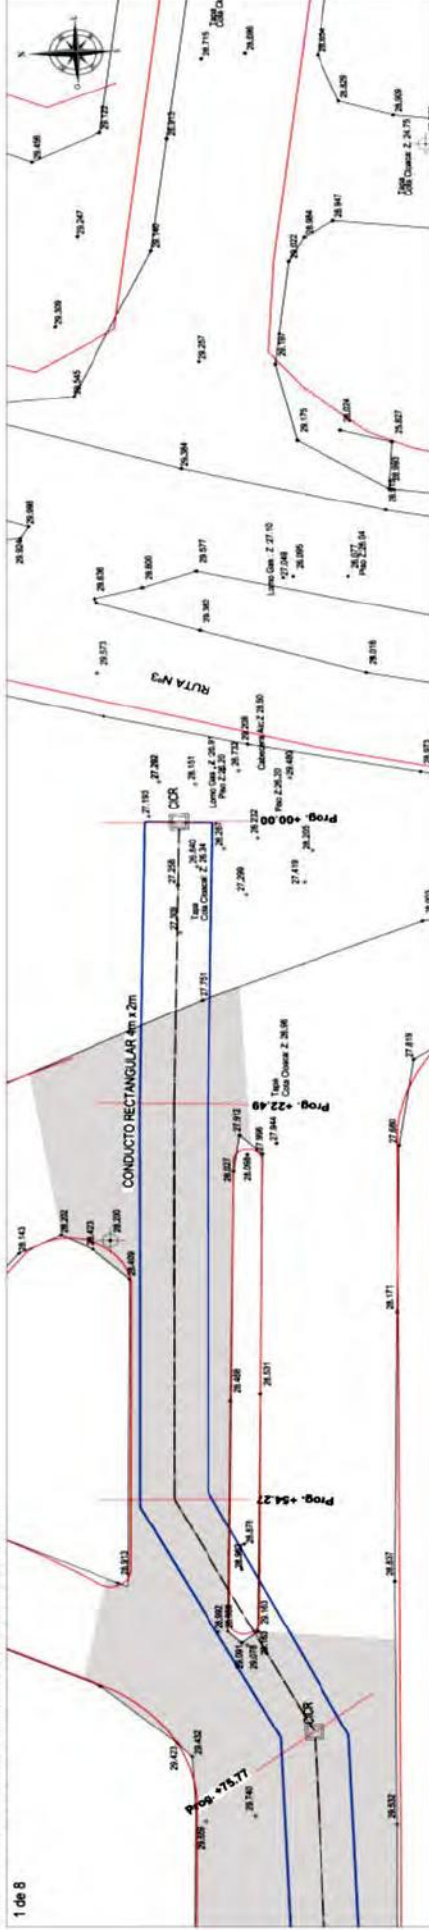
Planialtimetría de proyecto Tramo Progresiva 00 m. a 75.77 m.
